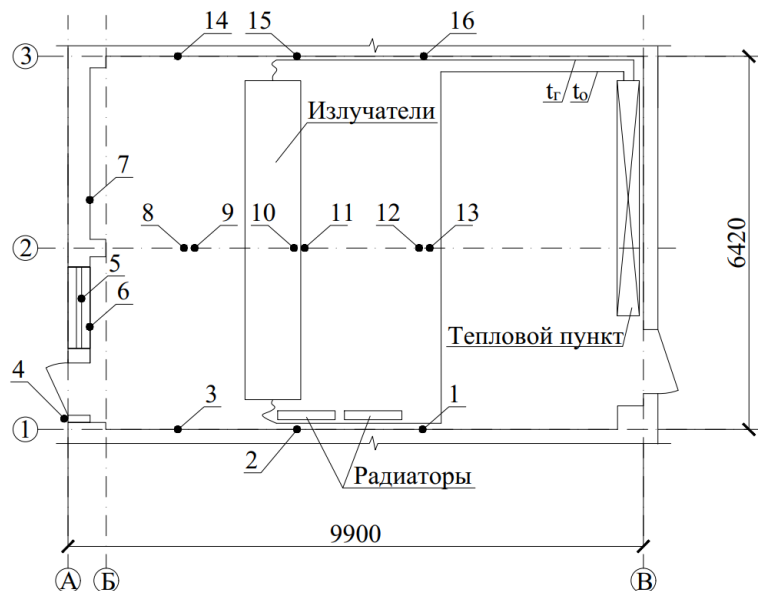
План помещения Лаборатории лучистого отопления и схема размещения датчиков температуры: 1 – на стене, 2 – на стене, 3 на стене, 4 – на улице, 5 – на окне, 6 – под окном на стене, 7 – на стене (под утеплителем), 8 – на полу, 9 – на потолке, 10 – на полу, 11 – на потолке, 12 – на полу, 13 – на потолке, 14 – на стене, 15 – на стене, 16 – на стене
